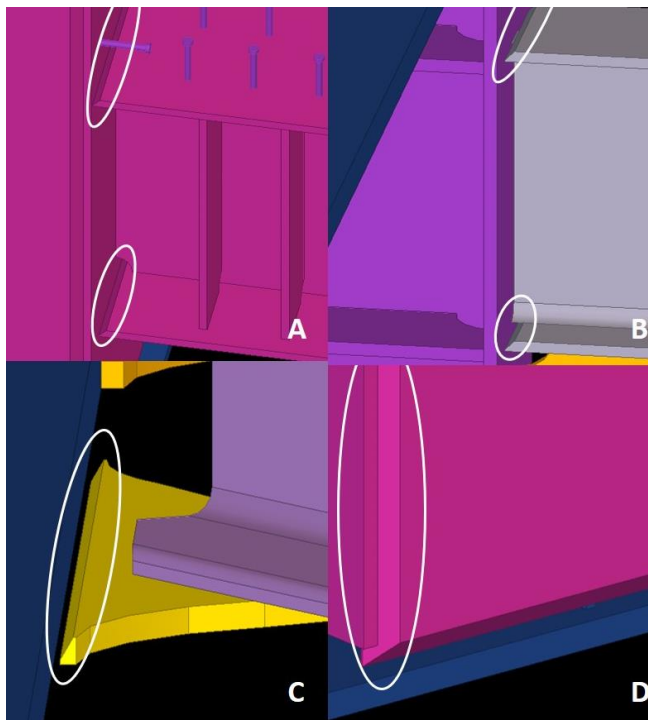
Alterações efetuadas ao tipo de junta de soldadura: A - Cordão de ligação das vigas nos topos da estrutura com os cachorros; B - Cordão de ligação das vigas das carlingas com os cachorros; C - Cordão de ligação entre as chapas que suportam os travamentos e o banzo inferior; D - Cordão vertical de ligação das chapas de topo da estrutura com os cachorros
